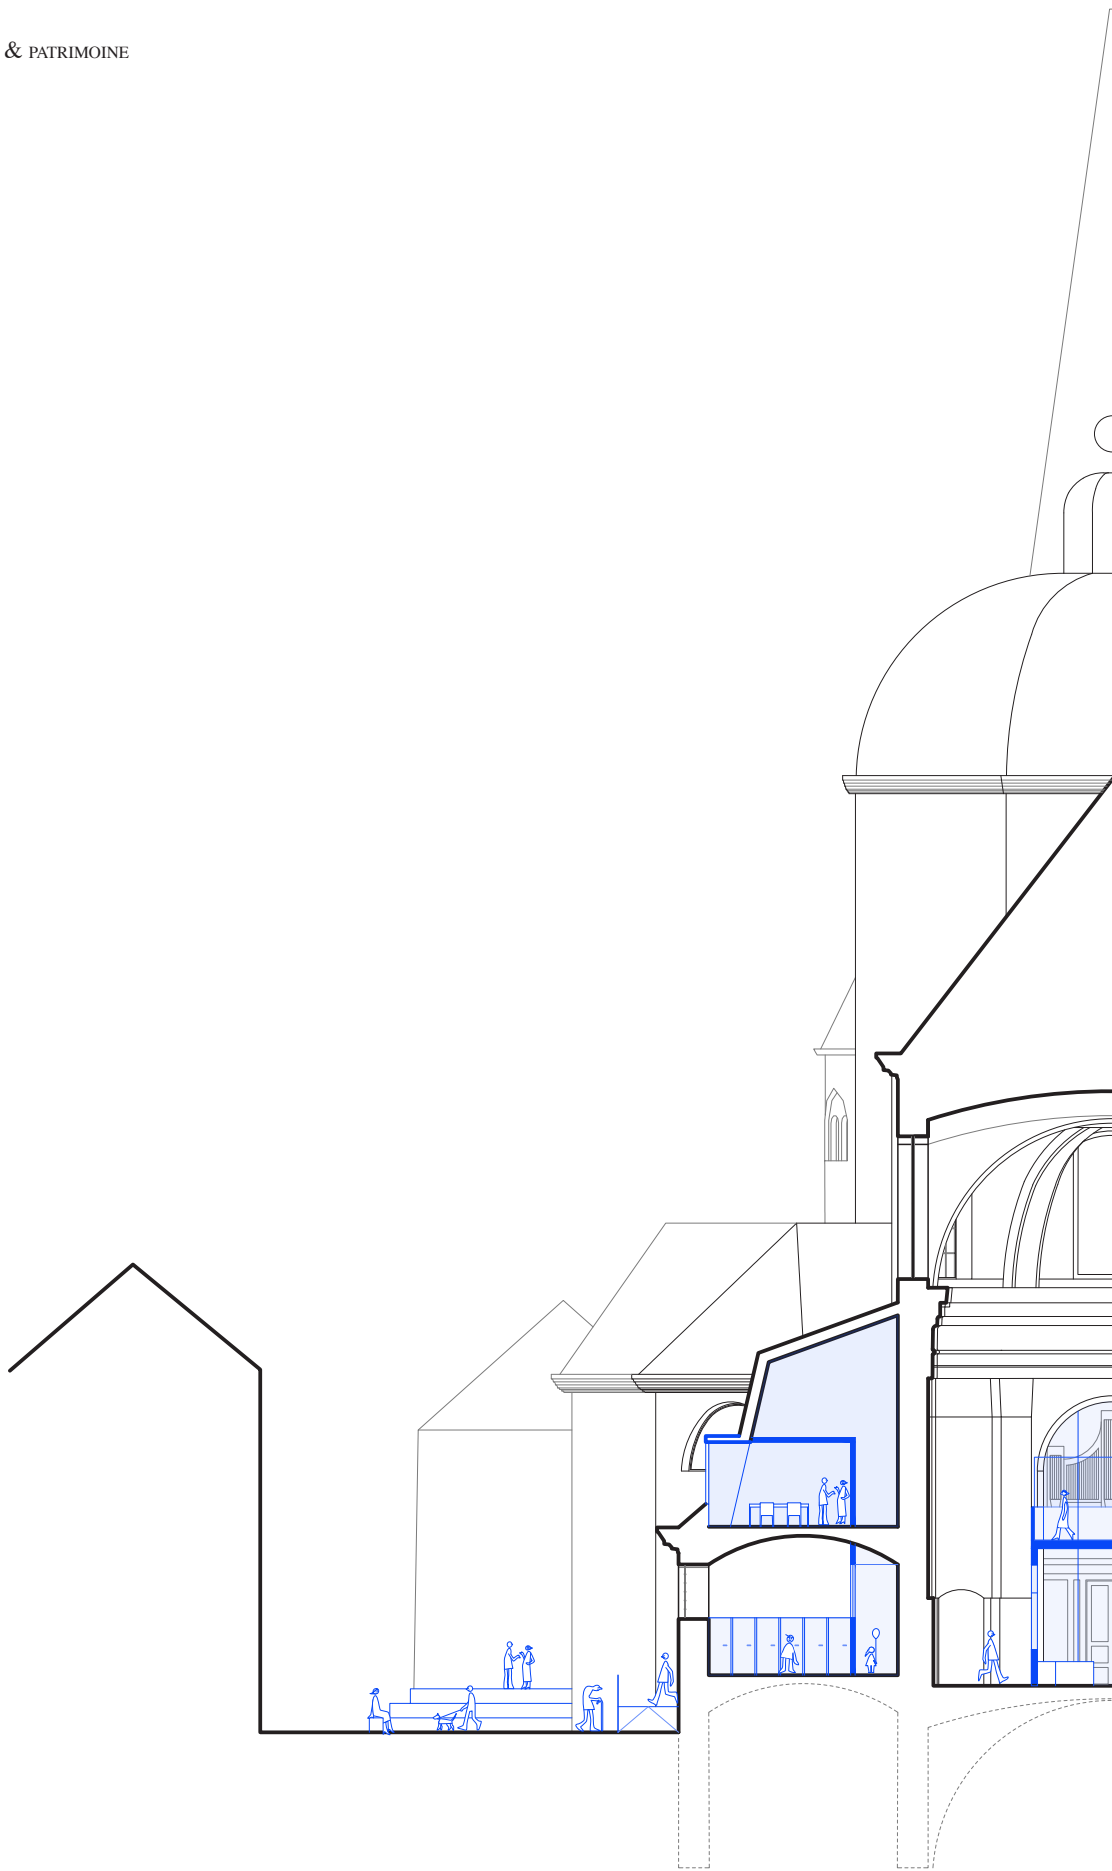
Situation projetée - Coupe transversale, C-C, 1/250°
